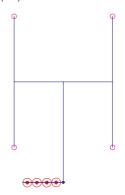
Пример разводки на 4 насадка в помещении квадратной (прямоугольной) формы
